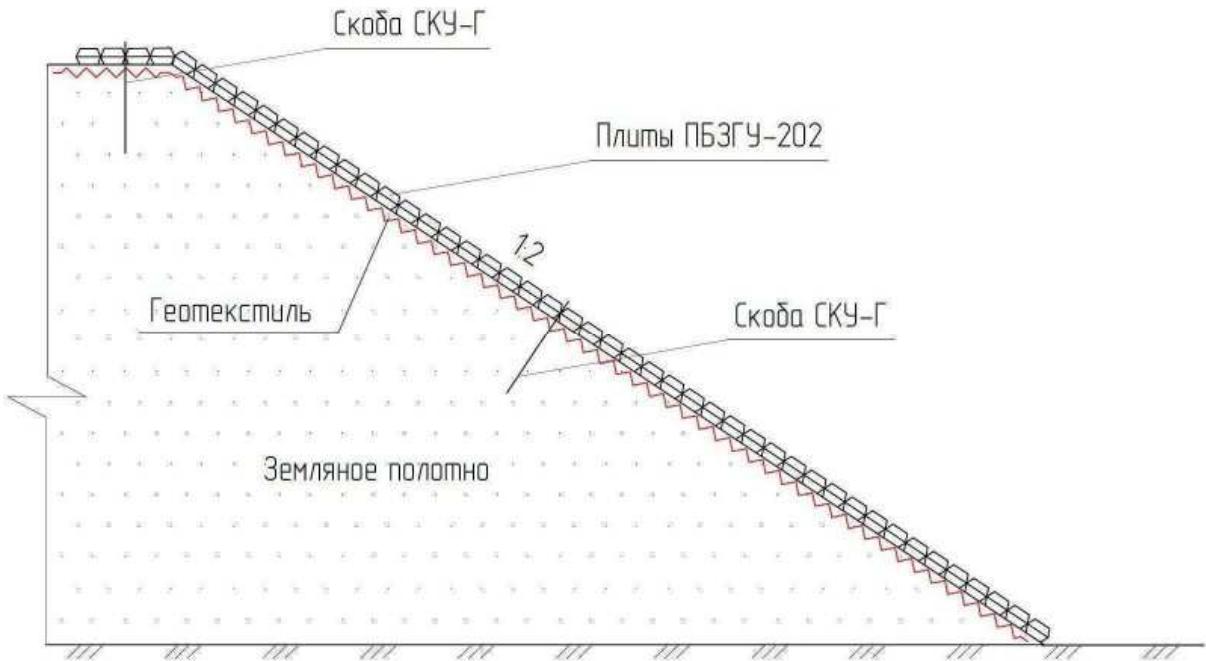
Схема защиты откосов подходных насыпей автомобильных дорог плитами покрытия бетонного гибкого защитного универсального (ПБЗГУ-202)
